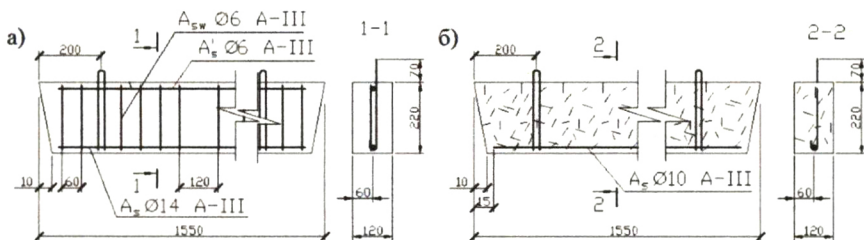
Перемычка ЗПБ16-37-п: а) с традиционным армированием б) на основе сталефибробетона
